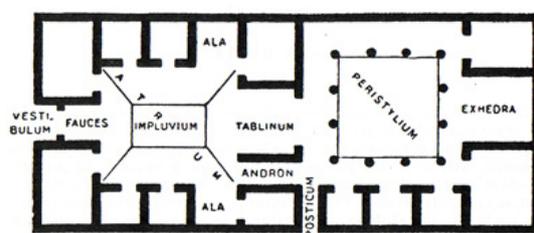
Planta Casa Pompeyana (Ravetllat, 1993)
